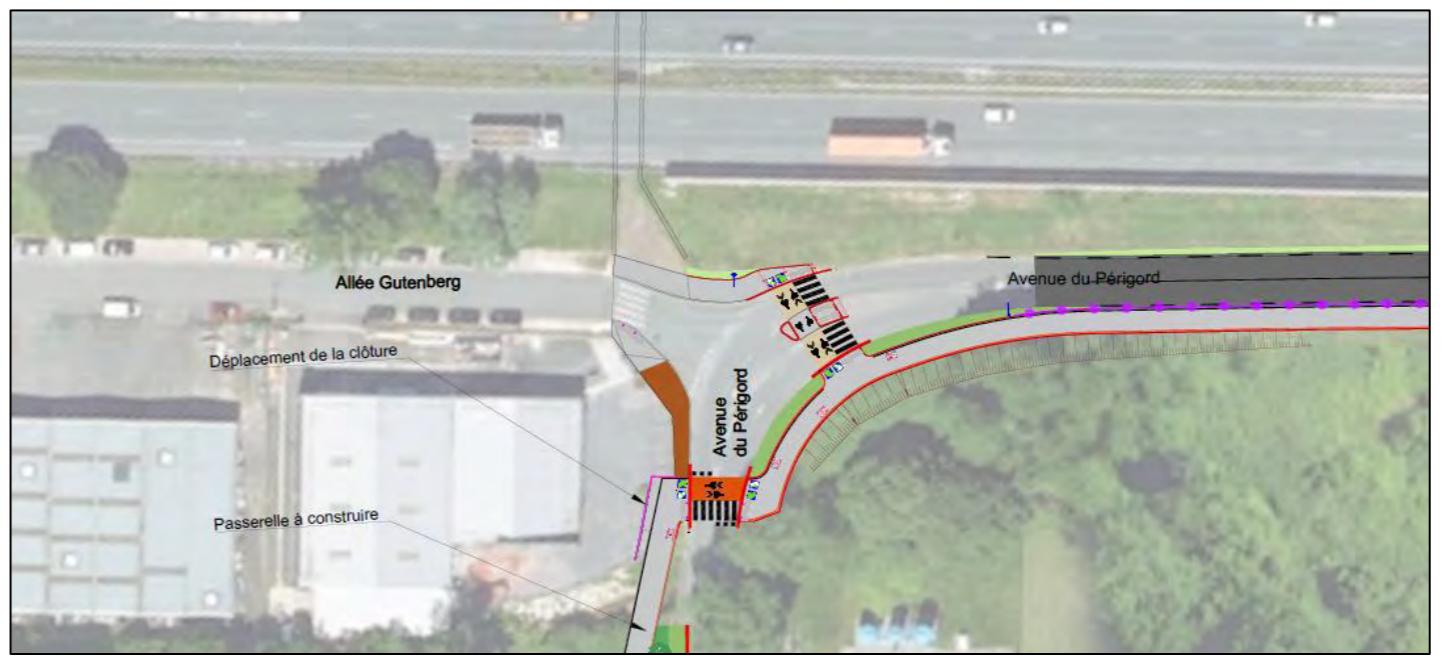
Aménagement du carrefour au droit du passage inférieur
